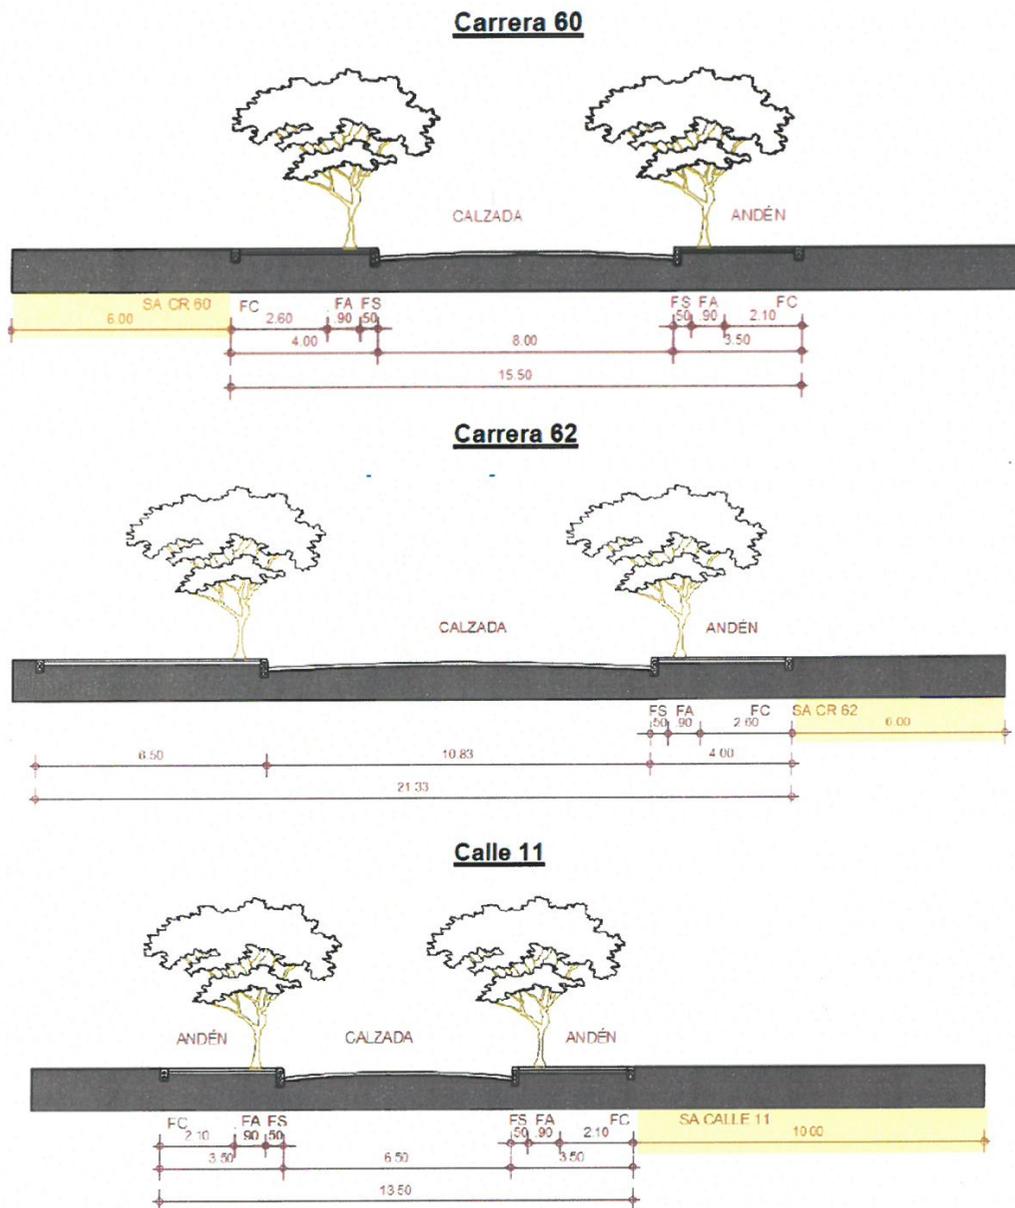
Reconfiguración de la sección vial Calle 11 y Calle 12
